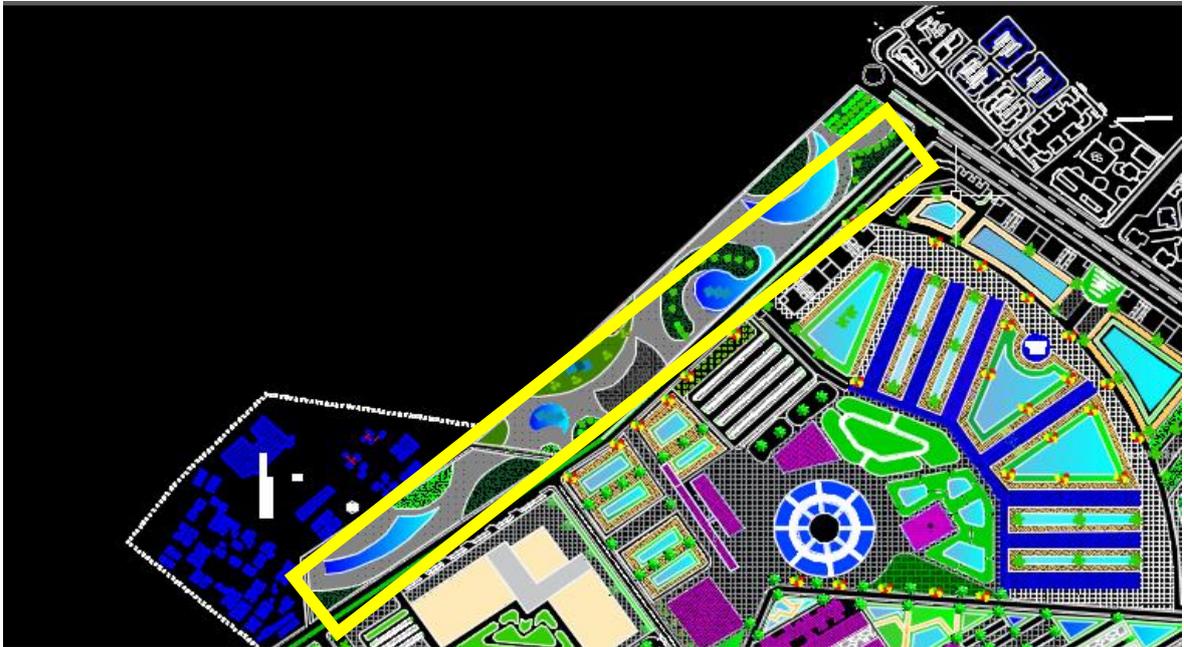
Vue en plan du jardin linéaire (entrée ouest de la ville) après l'intervention/
